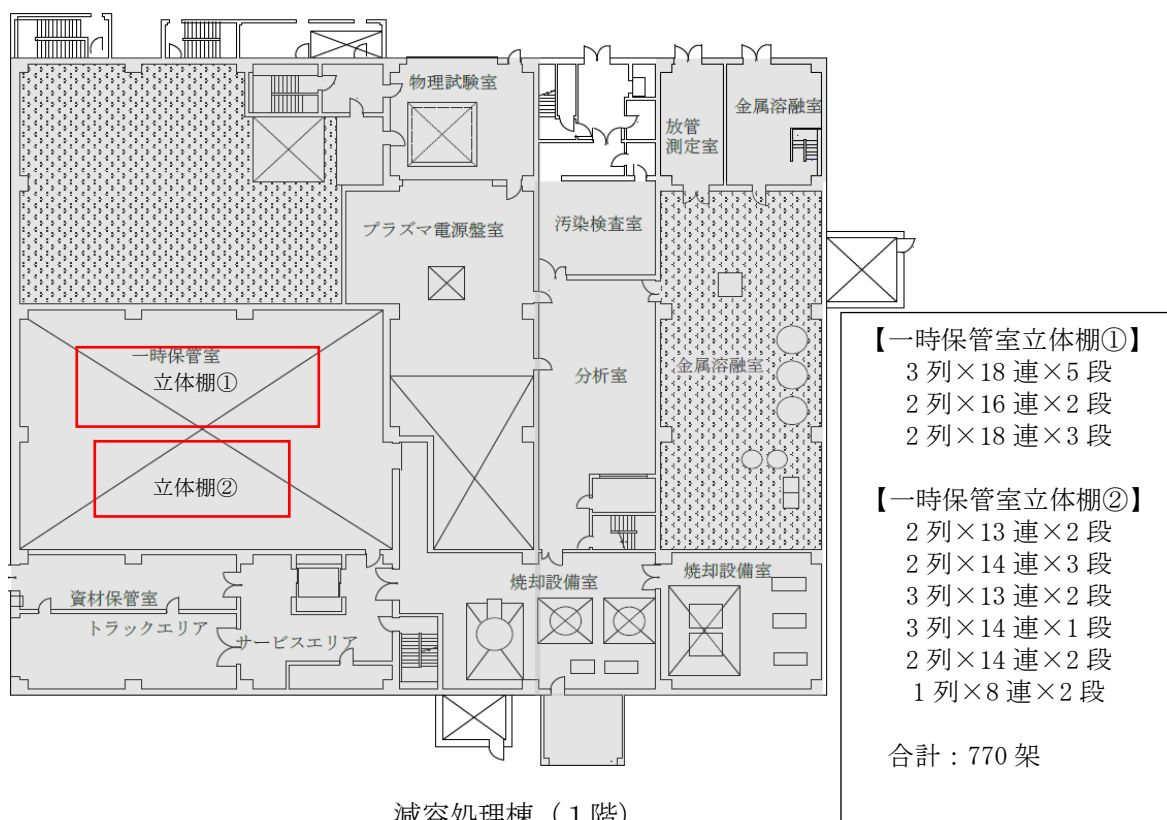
(2/3) 減容処理棟処理前及び発生廃棄物保管場所（一時保管室）平面図
